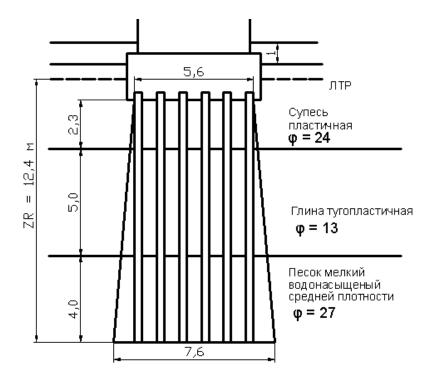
Схема определения условного массива для свайного фундамента Ширина подошвы условного массива, м:
